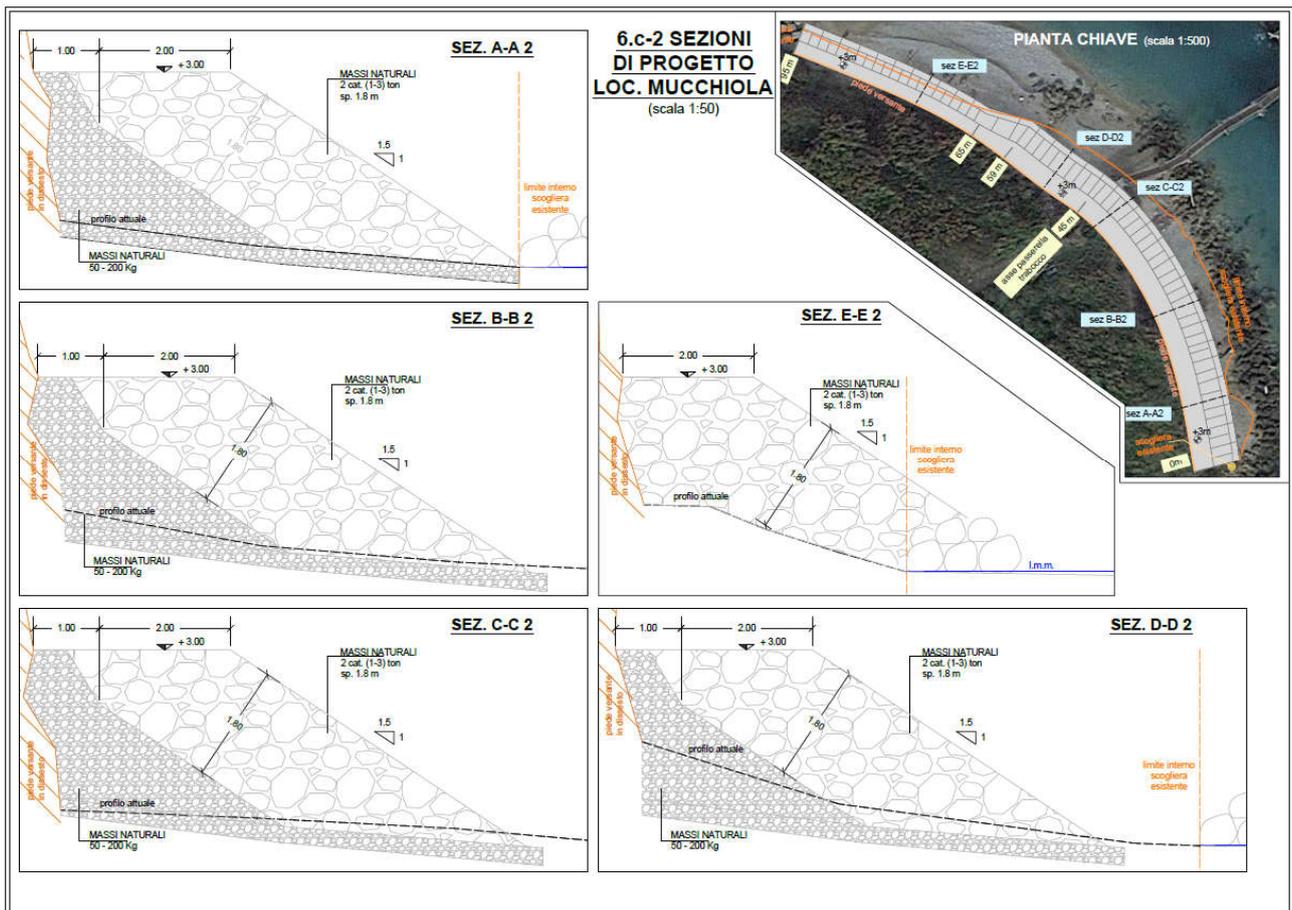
Planimetria e sezioni dell'opera in località Mucchiola.
